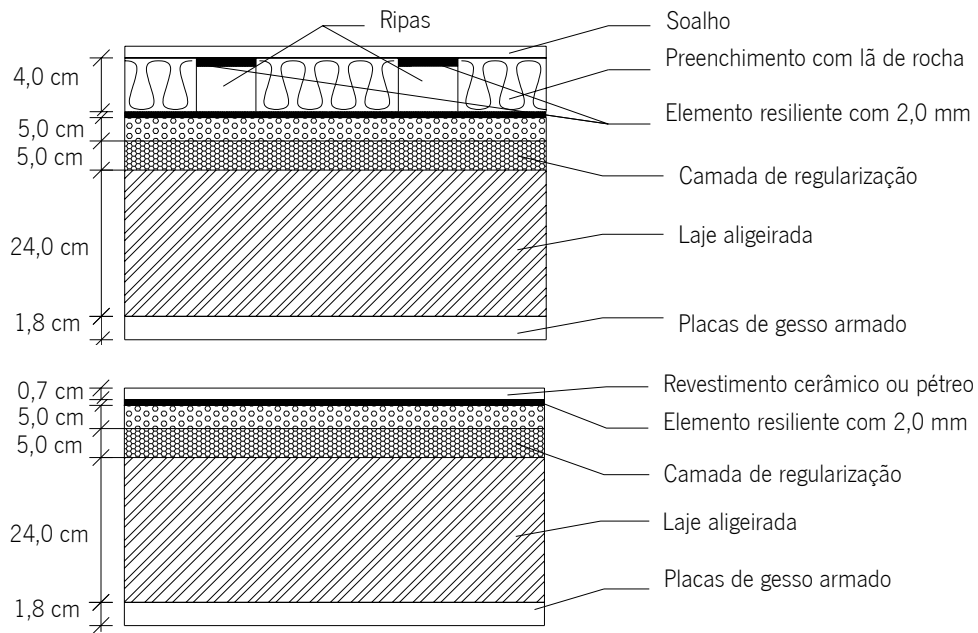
Pavimento de separação entre duas habitações com soalho de madeira e com material cerâmico ou pético - Pav1
